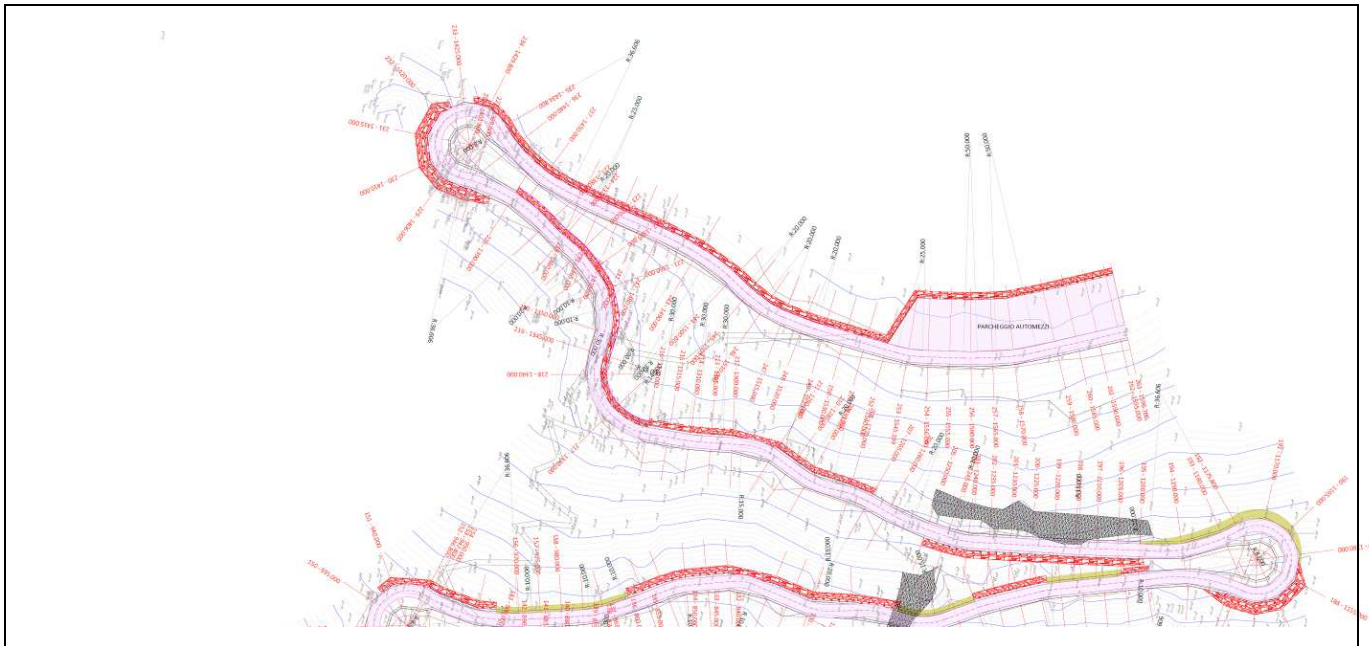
estratto planimetrico tratto finale [tavola B3 Studio Maraaffio]
